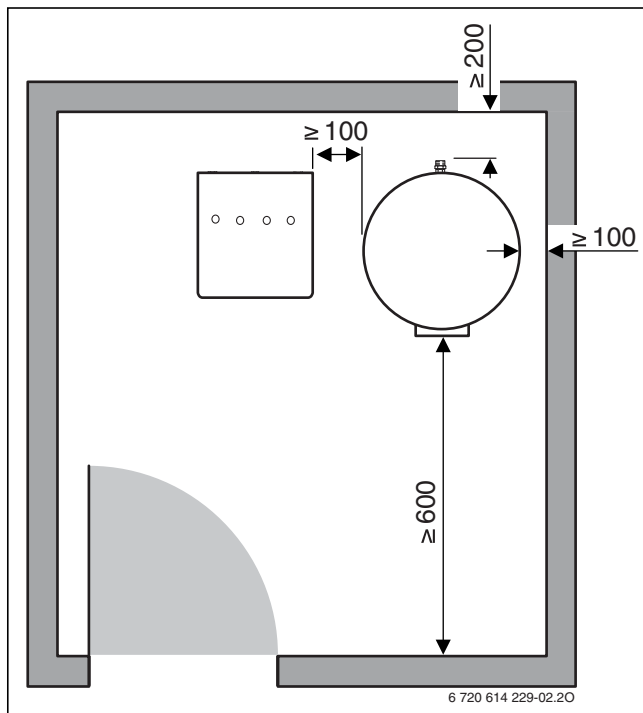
Distanze minime dalle pareti adiacenti (misure in mm)
